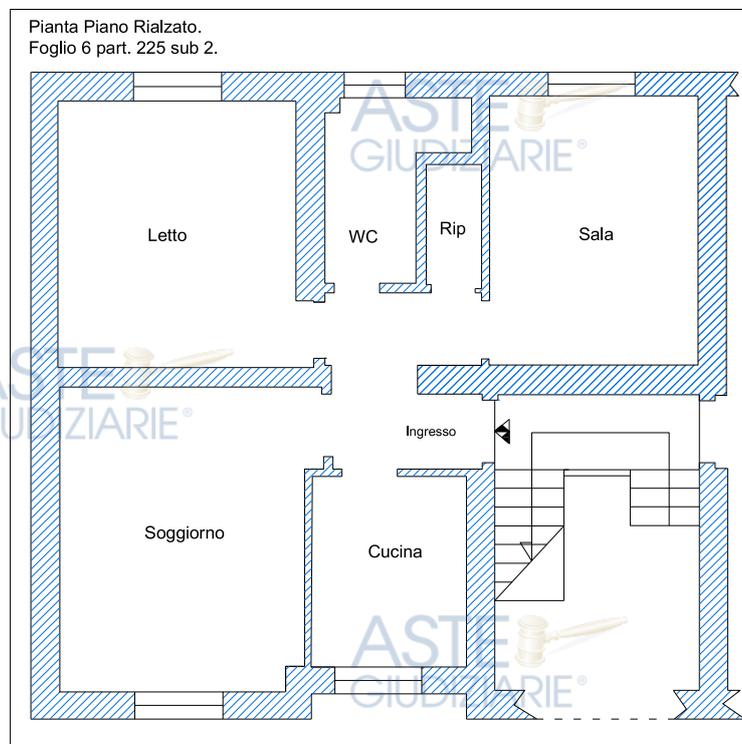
Planimetria stato di fatto rilevato durante il sopralluogo. Piano rialzato.
